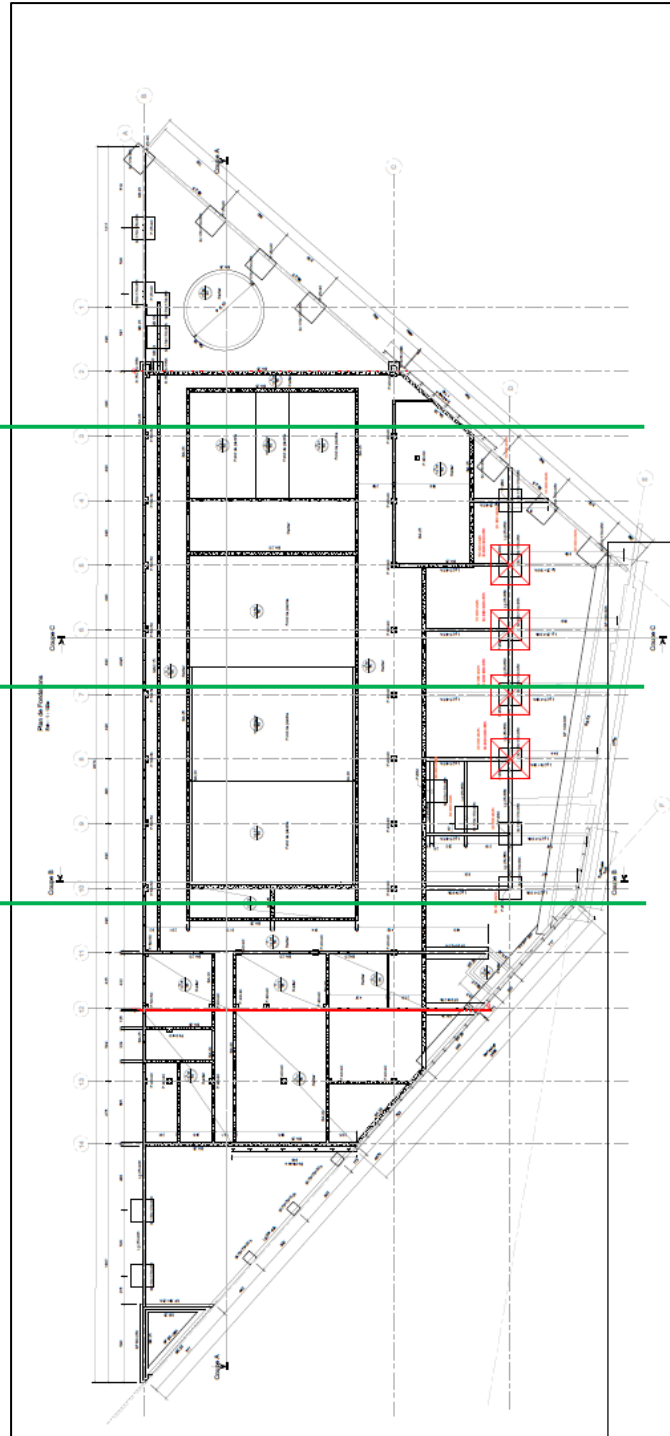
Plan de localisation des profils retenus ; Extrait plan de fondations plan 2101 PRO
